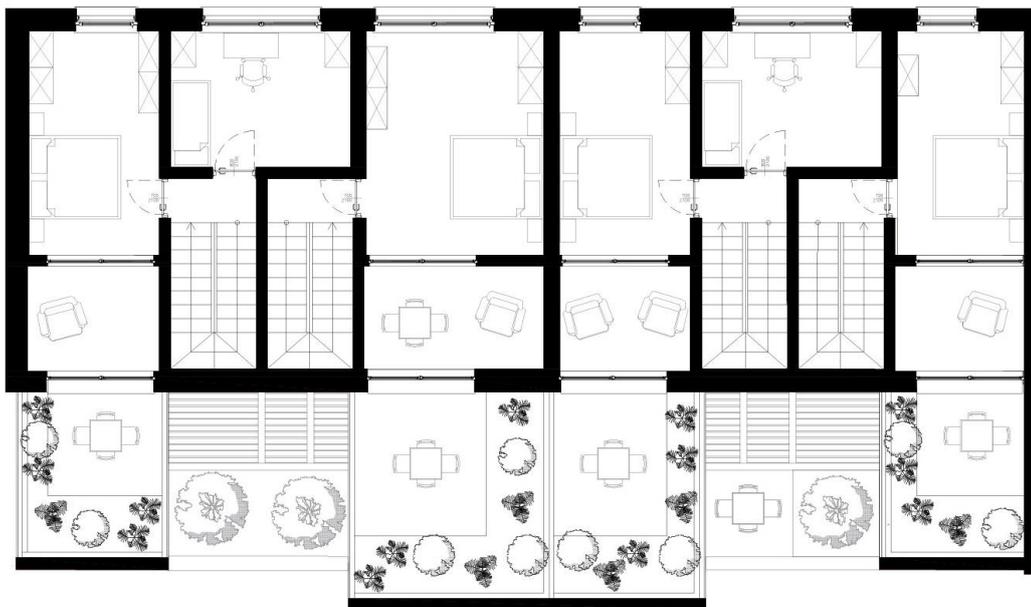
Pianta piano secondo sopraelevazione edificio Tipologia A
